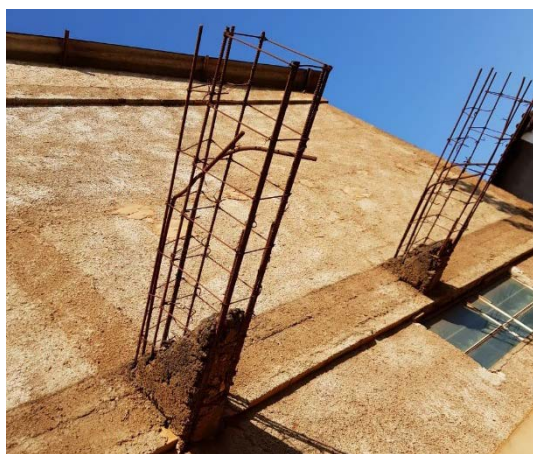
Armadura corroída em vigas inacabadas (Edificação 24)
